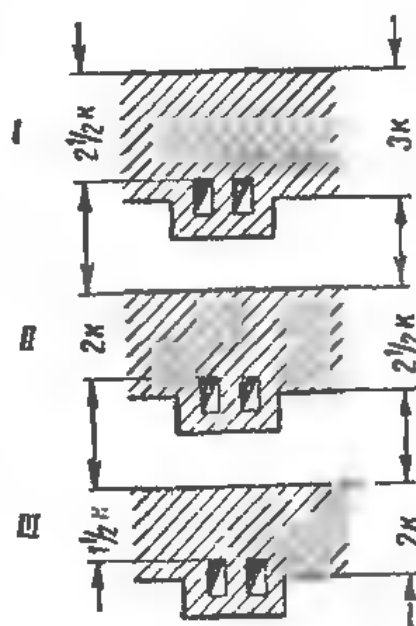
Толщина наружных стен для различных климатических поясов и утолщение в стенах для проходов дымовых каналов
